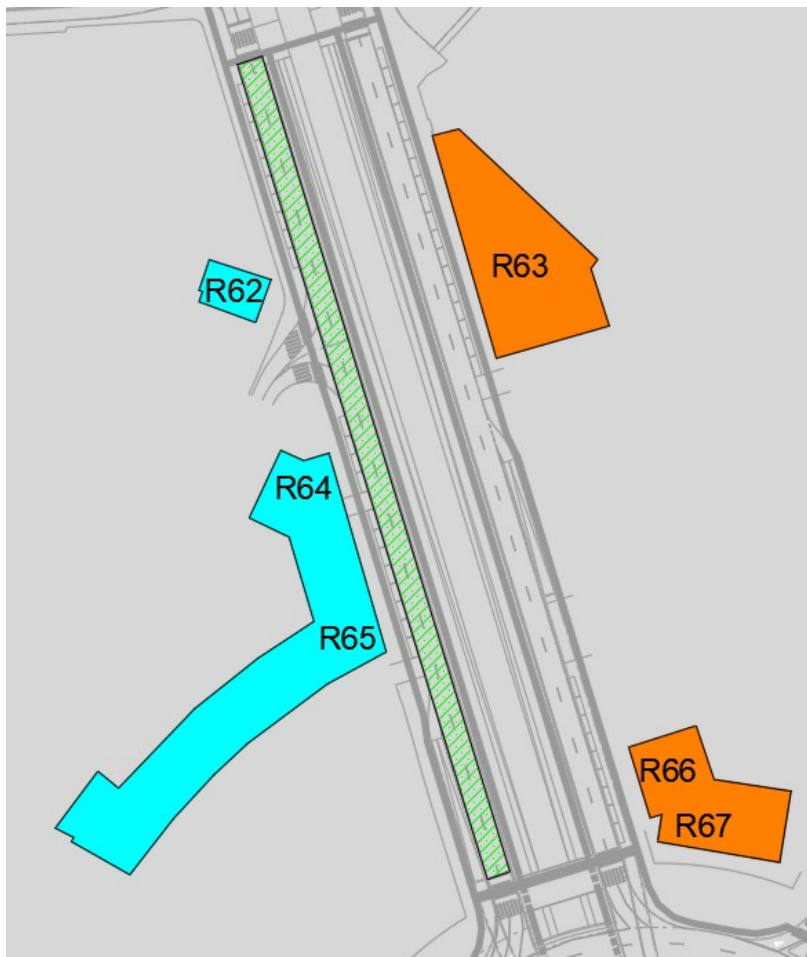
Área mínima de implantação de pavimento menos ruidoso (grelha verde) na zona de R62, R64 e R65
